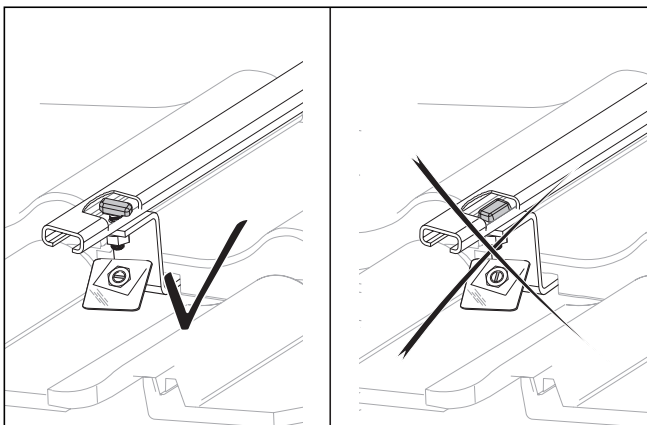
Hammerkopfschraube richtig verschrauben
